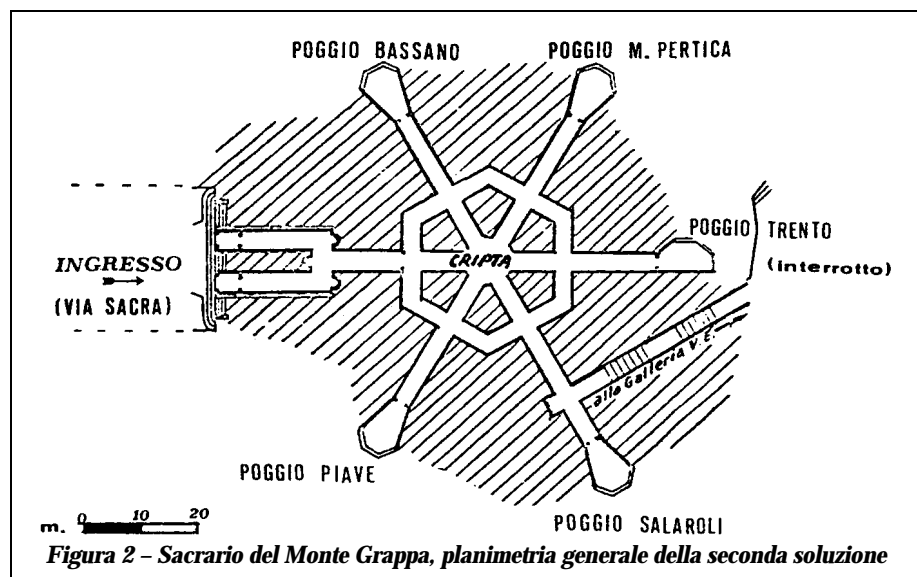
Sacario del Monte Grappa, planimetria generale della seconda soluzione
